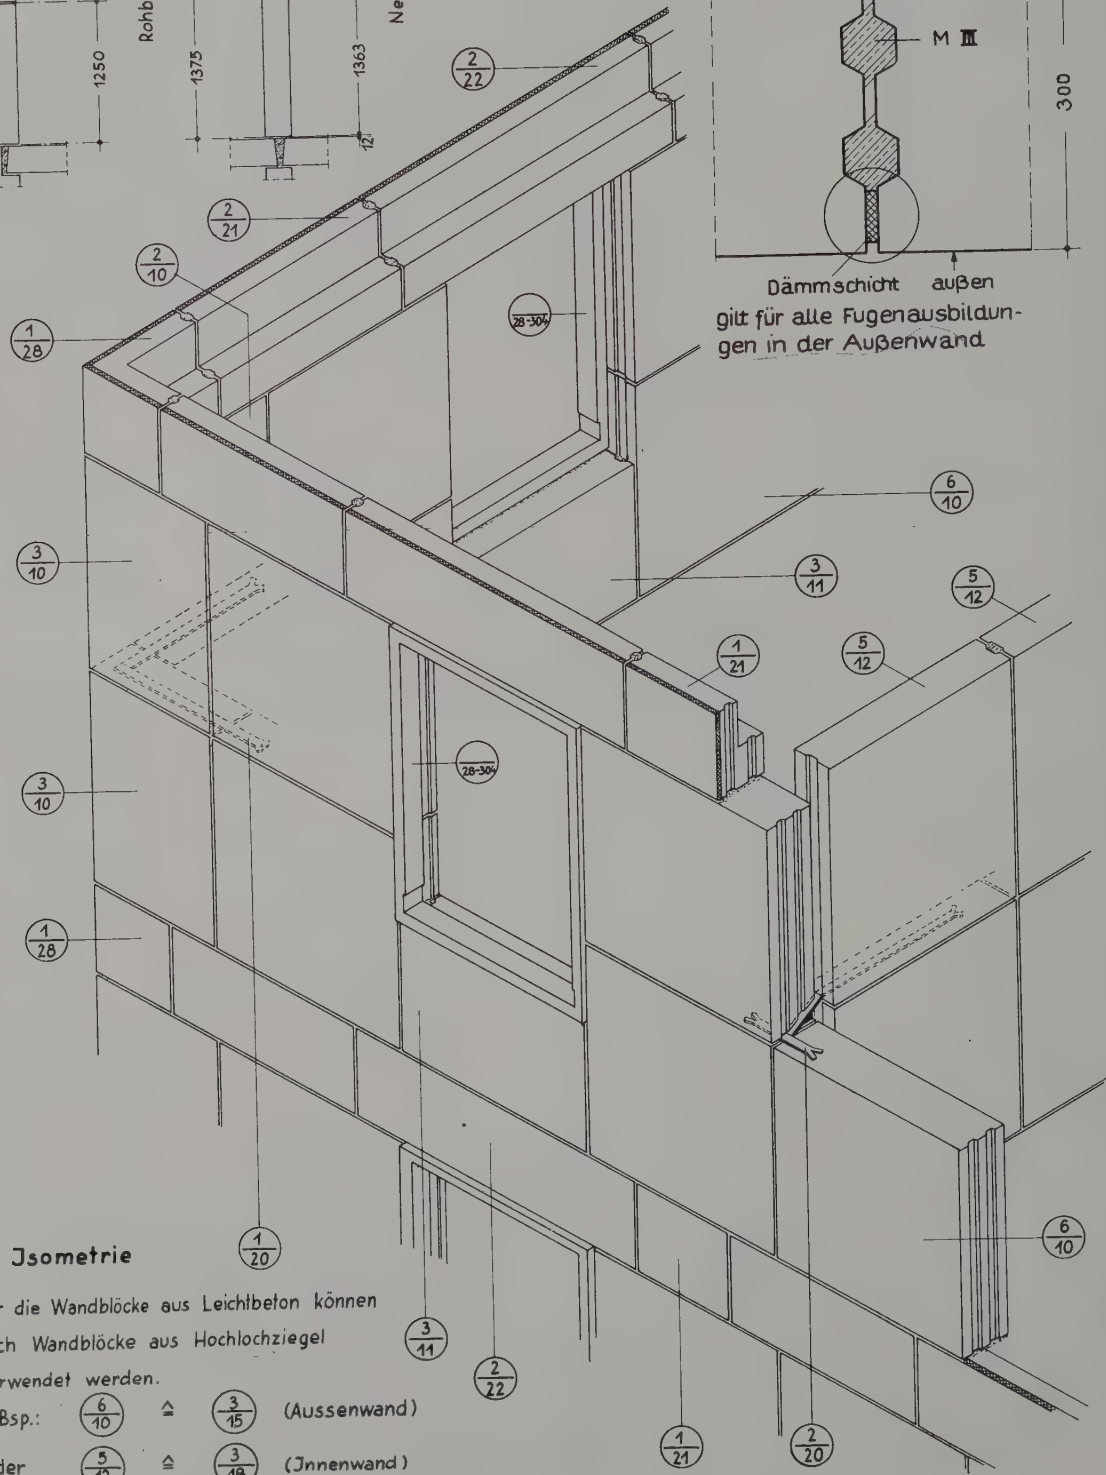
Wandblöcke aus Leichtbeton (Montageblatt)
